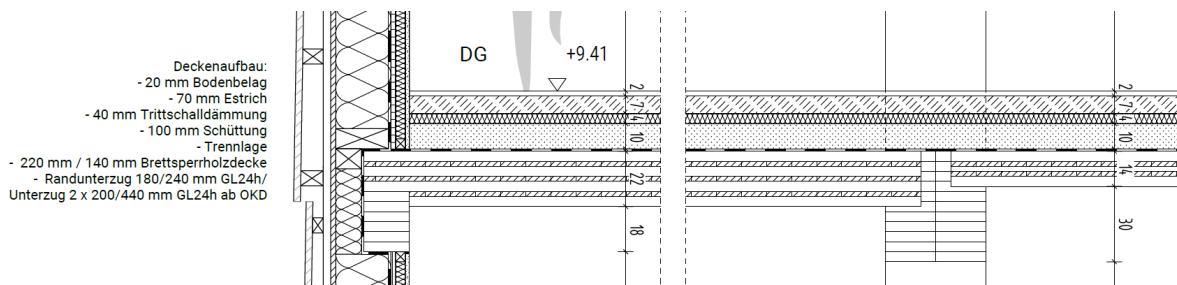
Fassadenschnitt durch Decke, Außenwand, Unterzug und Stütze
